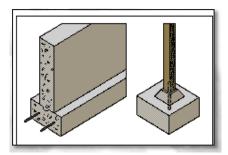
TIPO DE ZAPATAS Considerando que las zapatas aisladas son más adecuadas para soportar estructuras con claros grandes.
